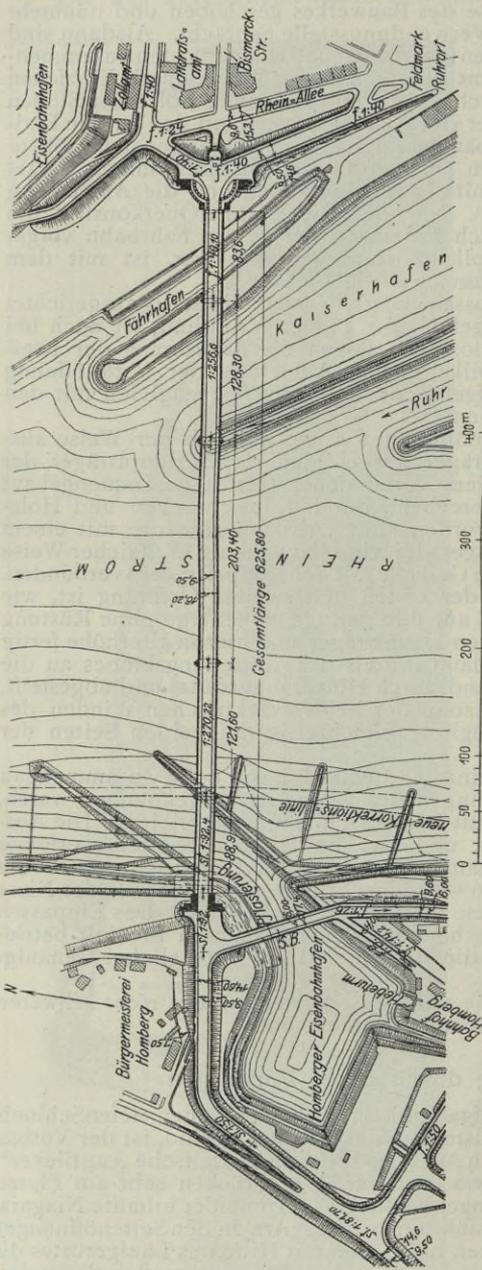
Lageplan der Rheinbrücke Ruhrort-Homburg. (D. B. Z. 1907, S. 630.)
